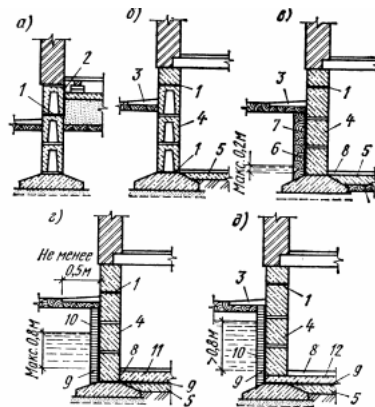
Ізоляція будинку від ґрунтової вологи: а, б – гідроізоляція при відсутності напору ґрунтових вод (а – будинок без підвалу; на інших рисунках – будинку з підвалом); у, м, д – те ж при напорі ґрунтових вод; 1 – горизонтальна гідроізоляція; 2 – те ж вертикальна; 3 – вимощення; 4 – стіна підвалу; 5 – бетонна підготовка; 6 – обмазка гарячим бітумом; 7 – м'ята жирна глина; 8 – чиста підлога; 9 – гідроізоляційний килим; 10 – захисна стінка; 11 – бетон; 12 – залізобетонна плита.
